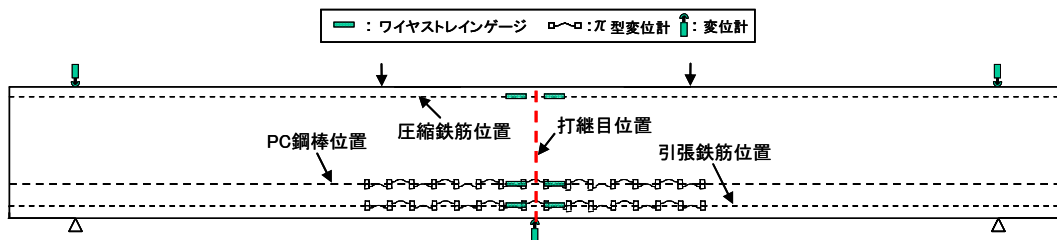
試験体の荷重状況および曲げひび割れ幅、ひずみ、たわみの測定位置
